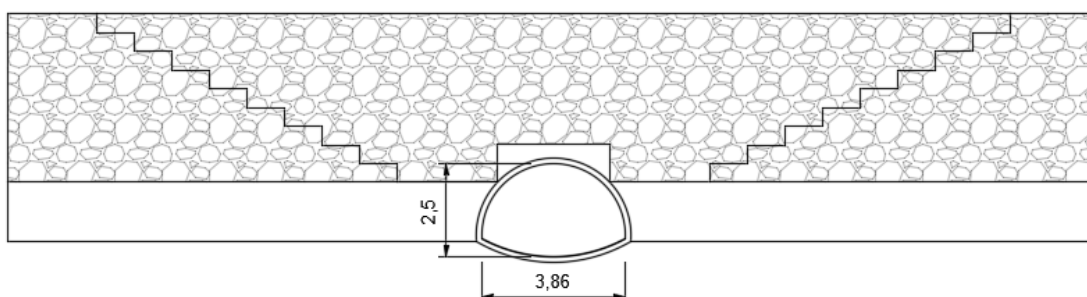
Vista de la descarga del arroyo Poncho Verde con sección abovedada. (Fuente: Elaboración propia)
